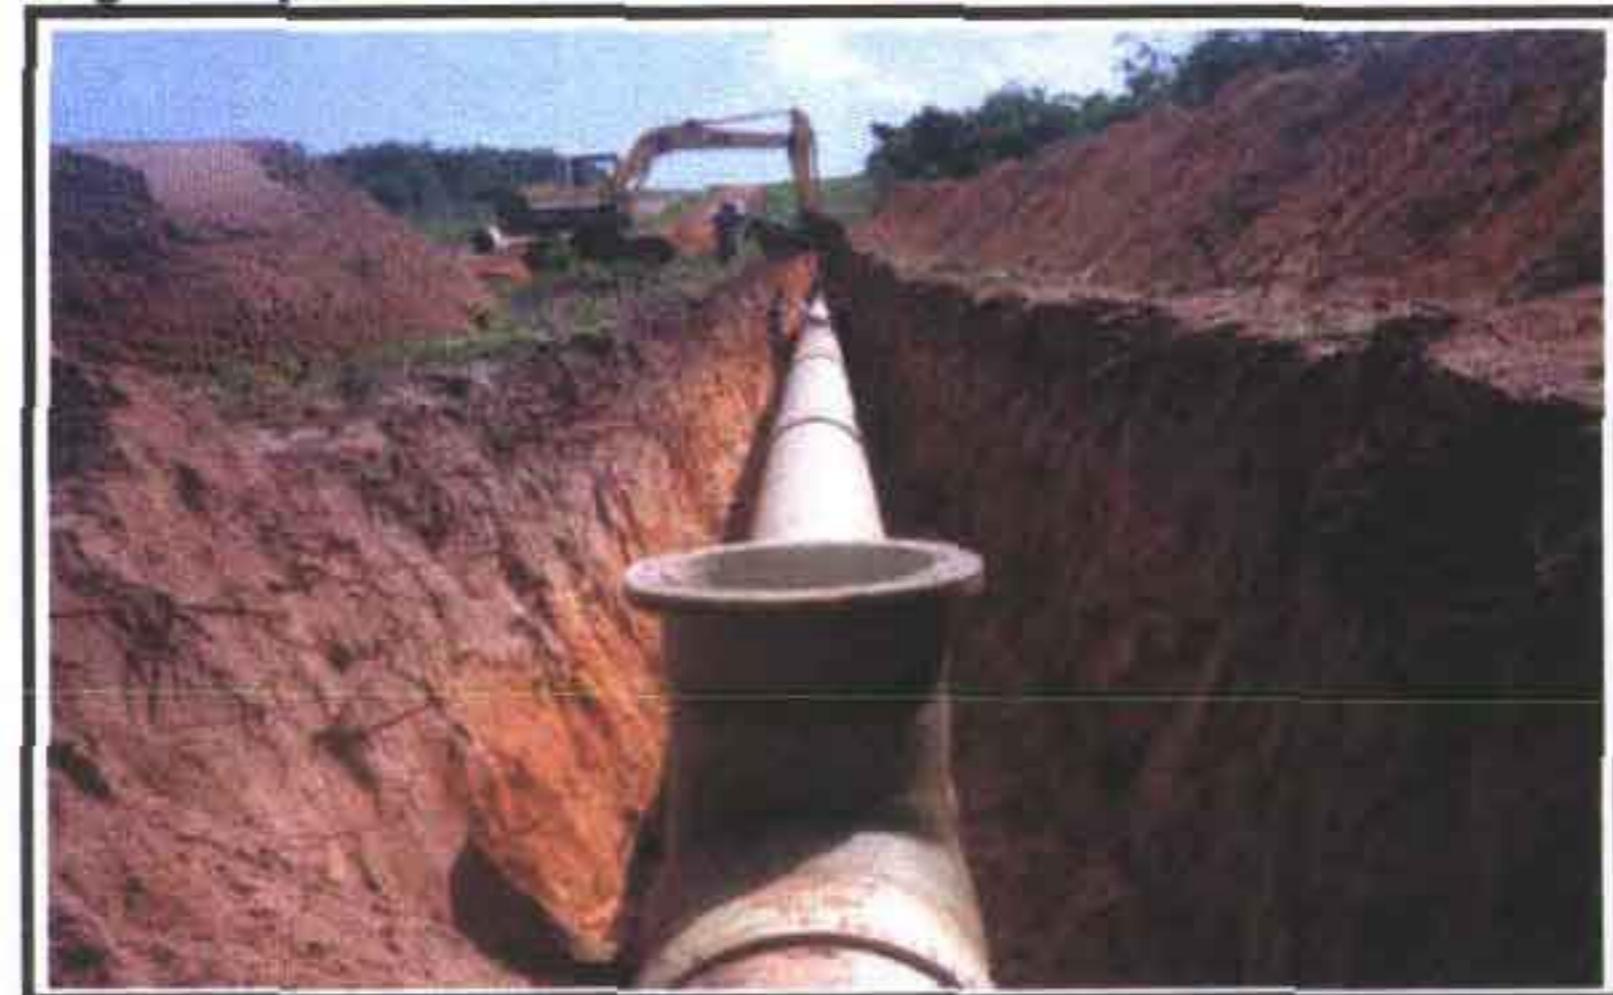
Assentamento de tubulação, executado com a utilização do equipamento de escavação de vala: retroescavadeira sobre esteira.
